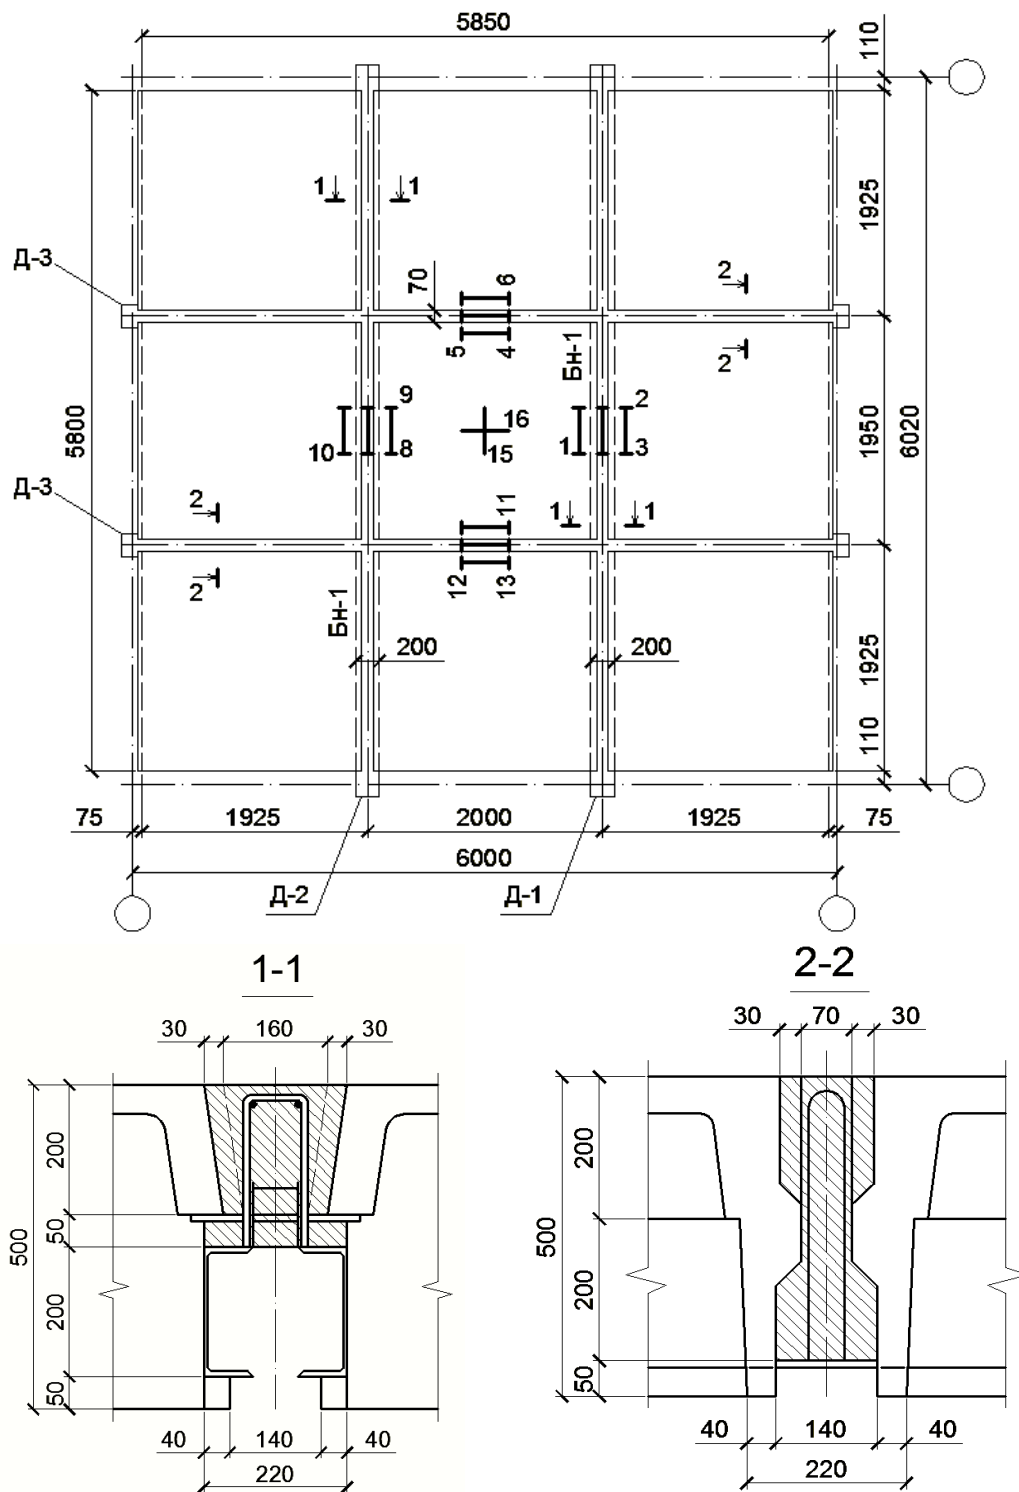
План і перерізи сталезалізобетонного перекриття:
